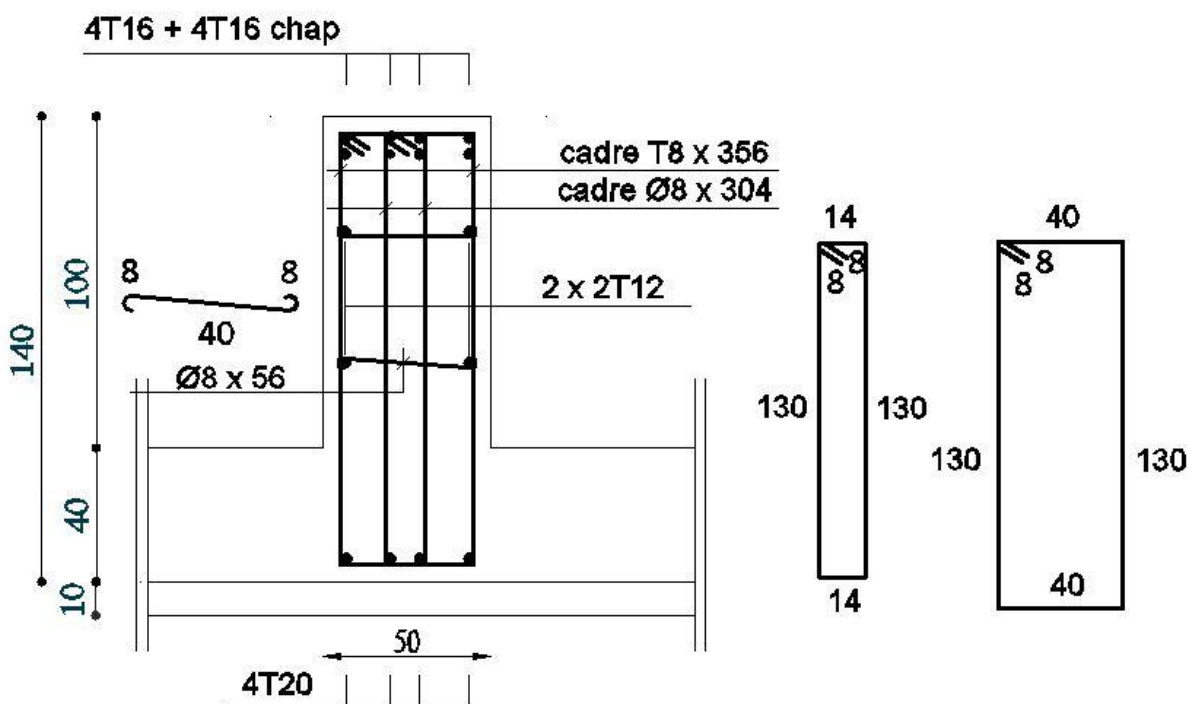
dessin de ferrailage d'une poutre secondaire en travée.
